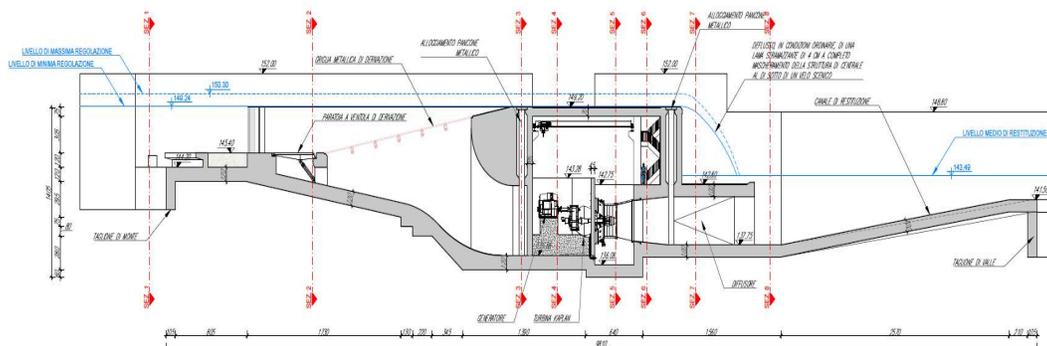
Profilo di progetto dell'impianto idroelettrico
